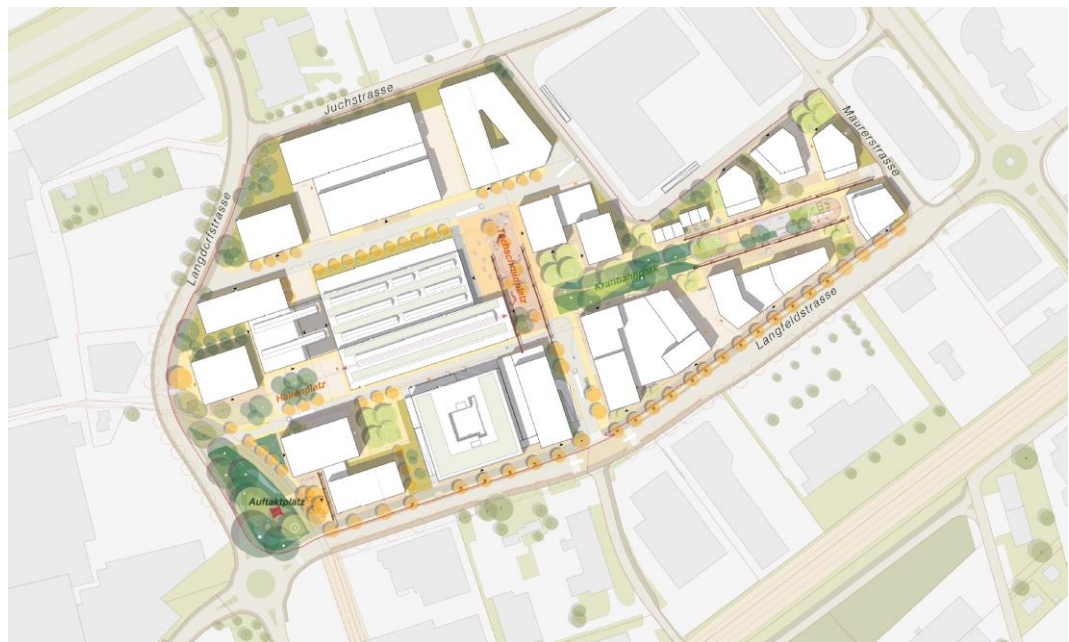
Möglicher Bebauungs- und Freiraumplan
